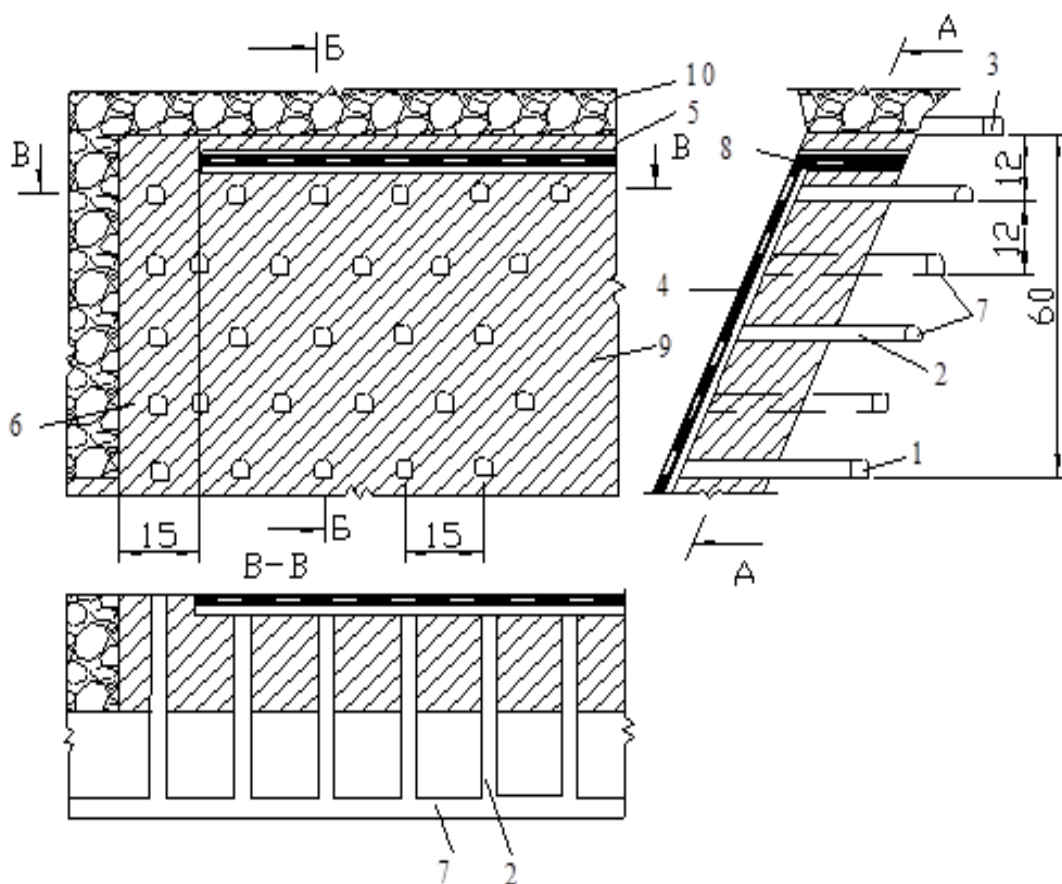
Подэтажным обрушение с гибким перекрытием: 1 и 3 – транспортный и вентиляционный штрек; 2 – буровой орт; 4 – гибкое перекрытие; 5 и 6 – целики; 7 – доставочные штреки; 8 – монтажный слой; 9 – руда; 10 – обрушение.
